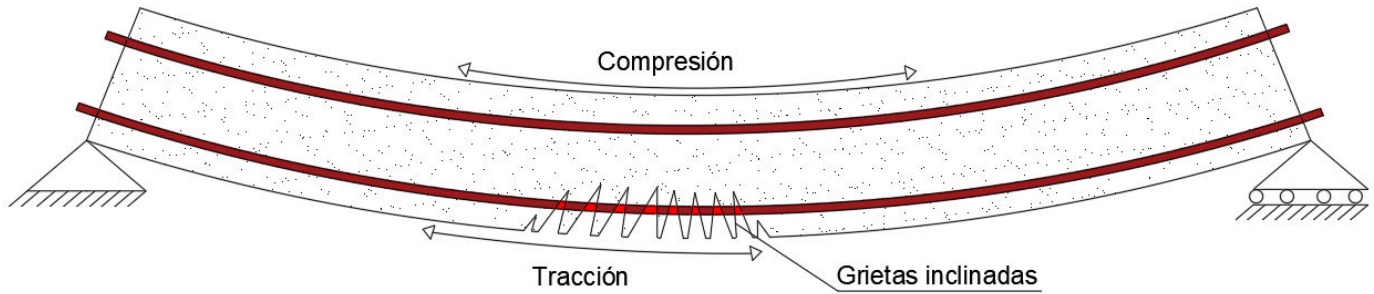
Agrietamiento vertical en la cara inferior de la viga.
